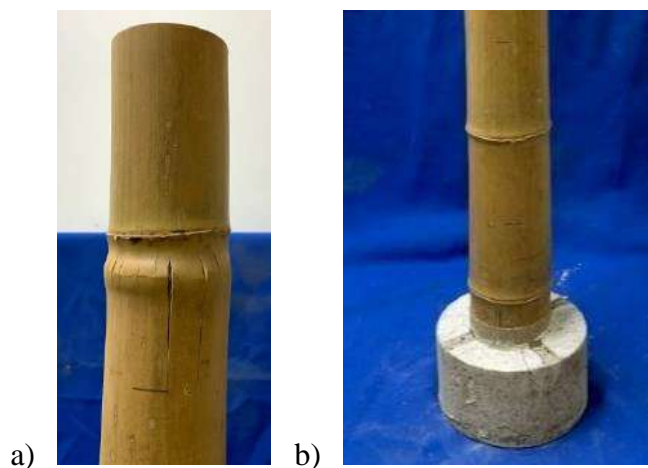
a) Fissuras visíveis no colmo pós ensaio de resistência à compressão . b) Fissuração do concreto da base.
